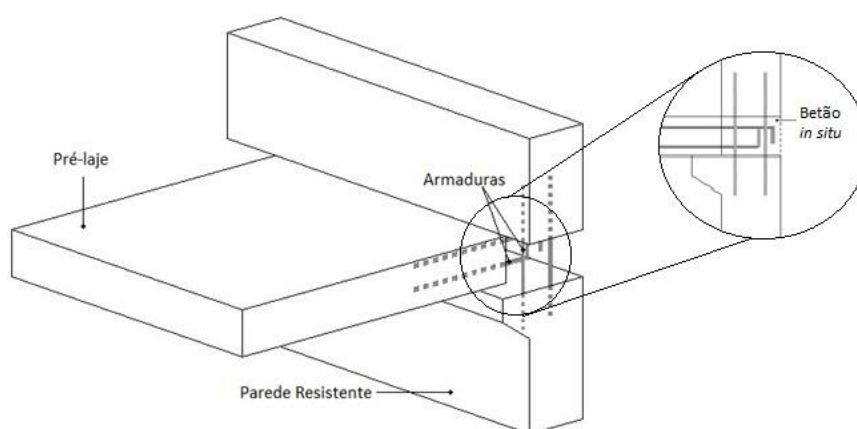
Ligação Laje – Parede com betonagem *in situ* do nó
